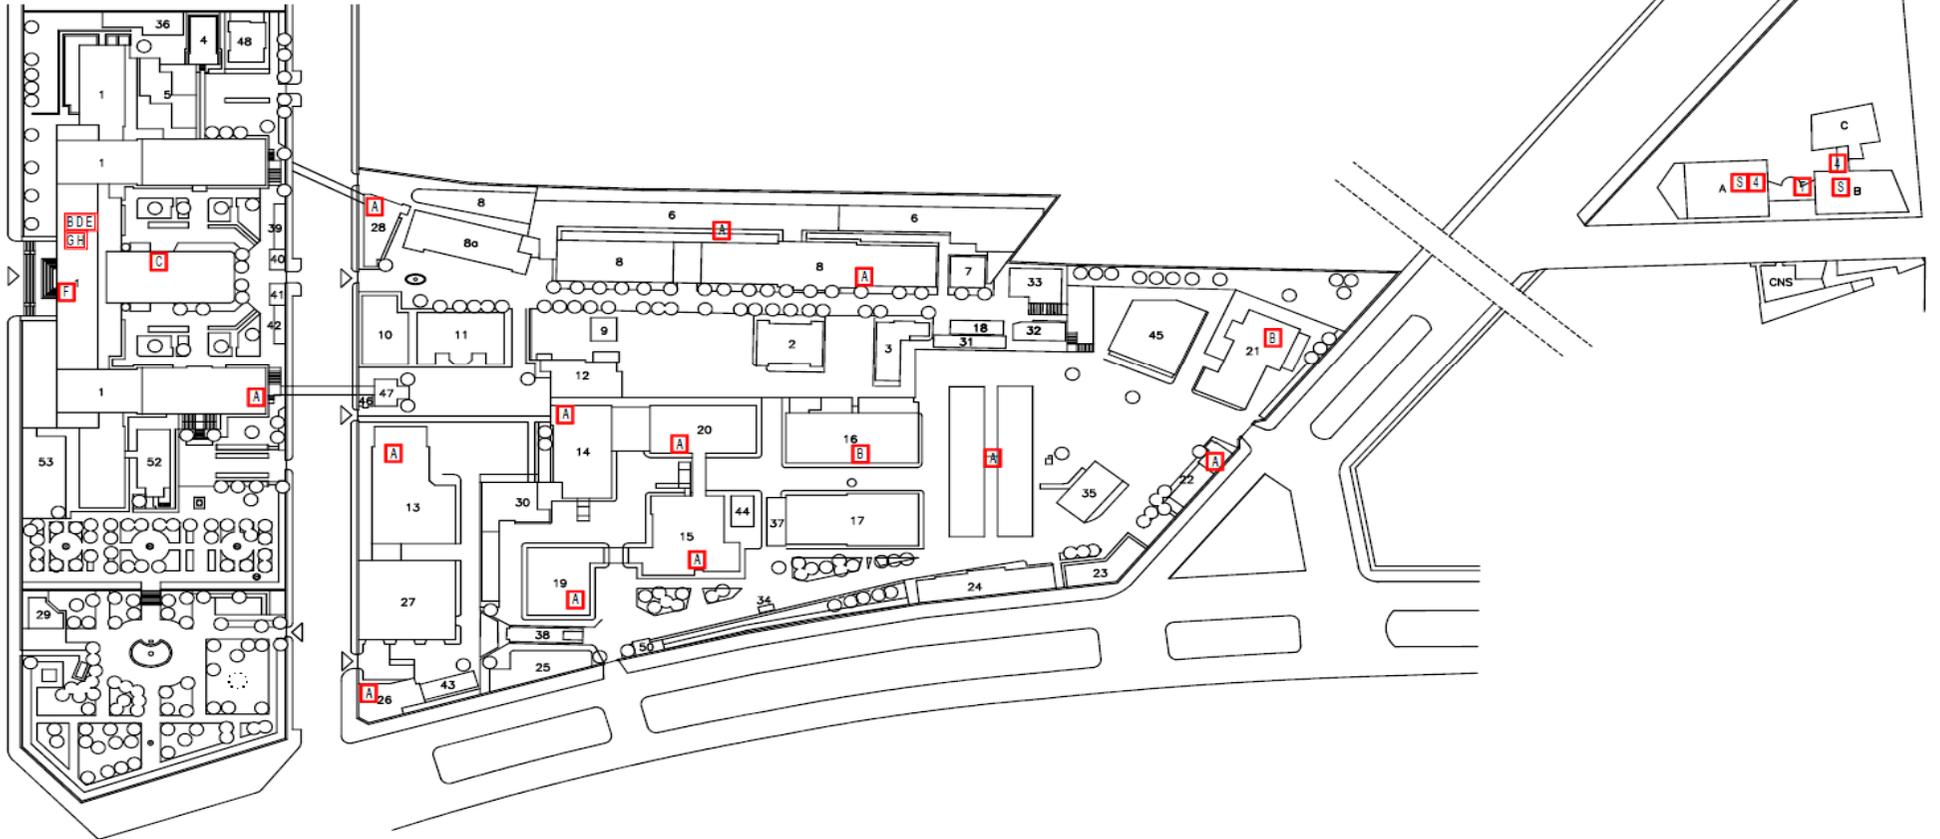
Planimetria Ubicazione Armadi D.P.I
